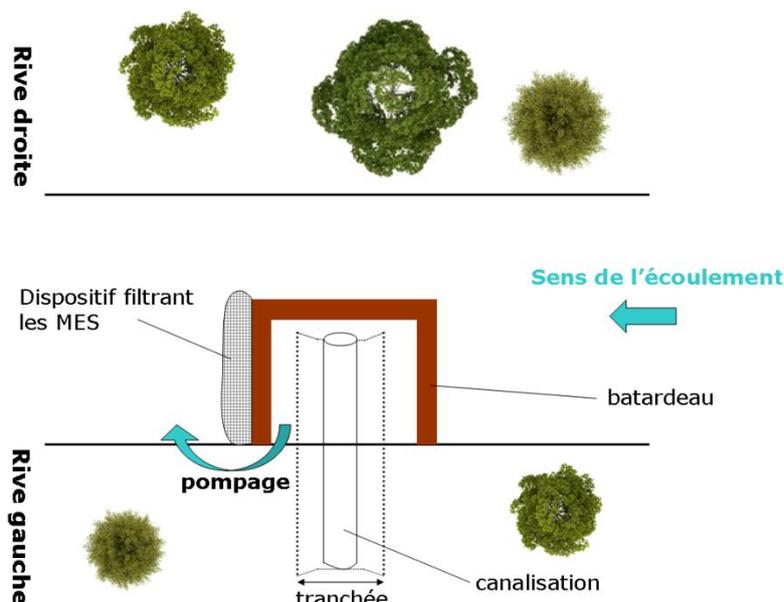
Schéma détaillant les travaux par demi-section de cours d'eau
